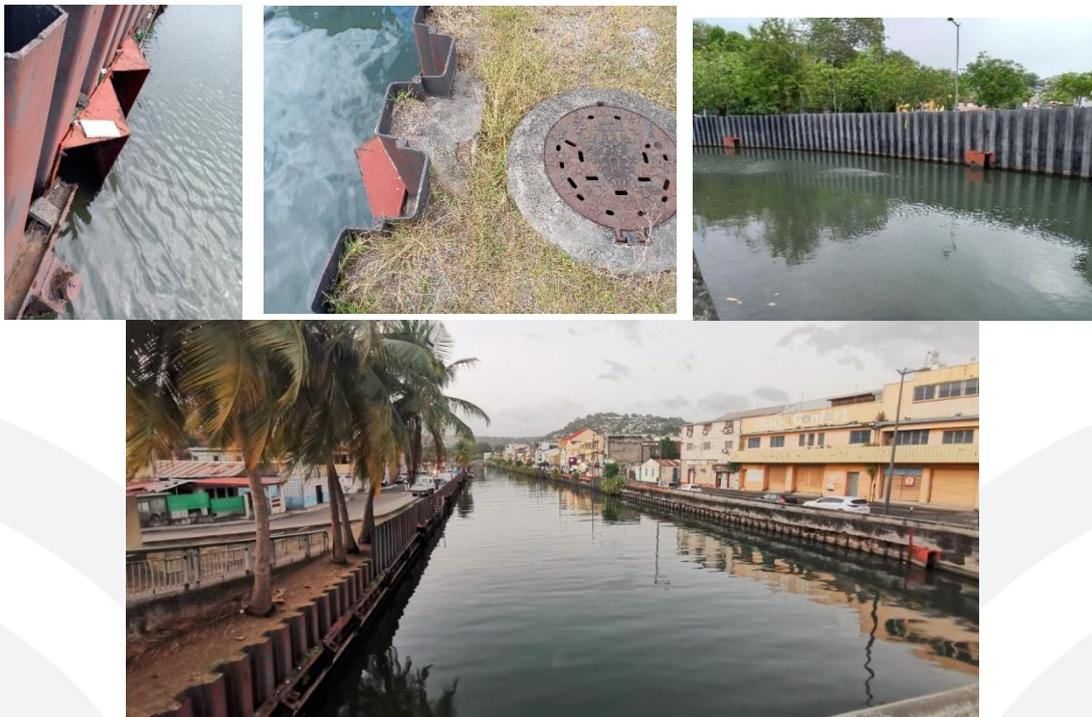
Canal Levassor et exutoires (source : Suez Consulting, Avril/Mai 2022)
